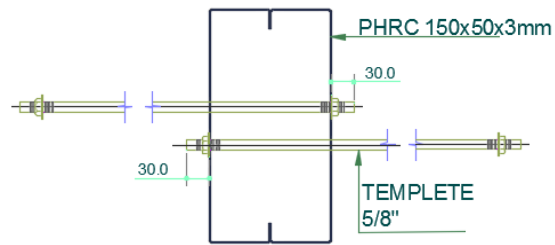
Detalle conexión templete, zona B. Fuente: Autor.
